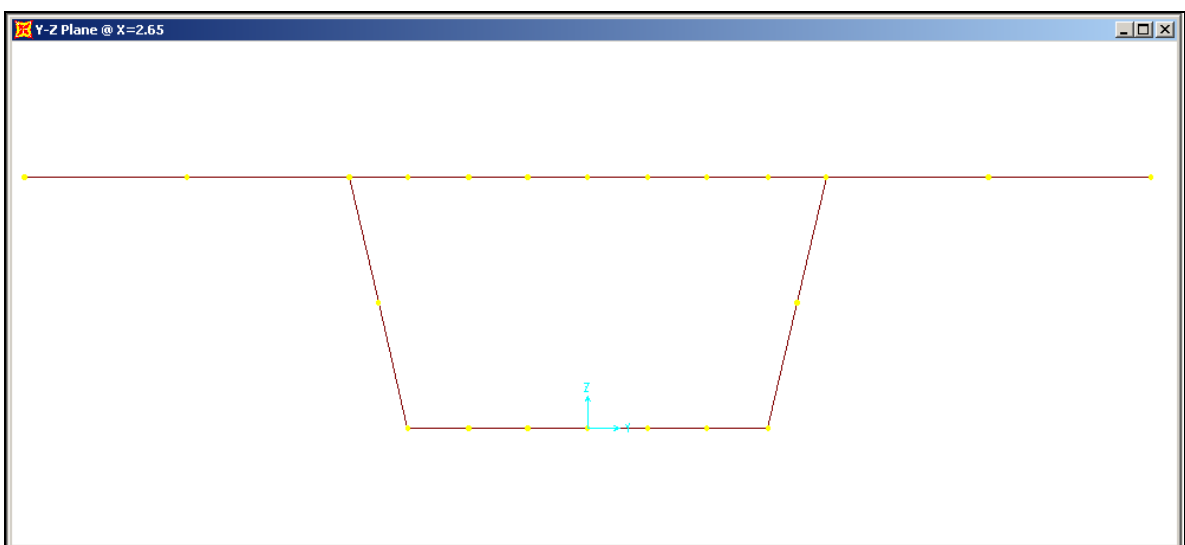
Sección transversal del puente de sección cajón mixto y su discretización en SAP2000. Fuente: Autores
